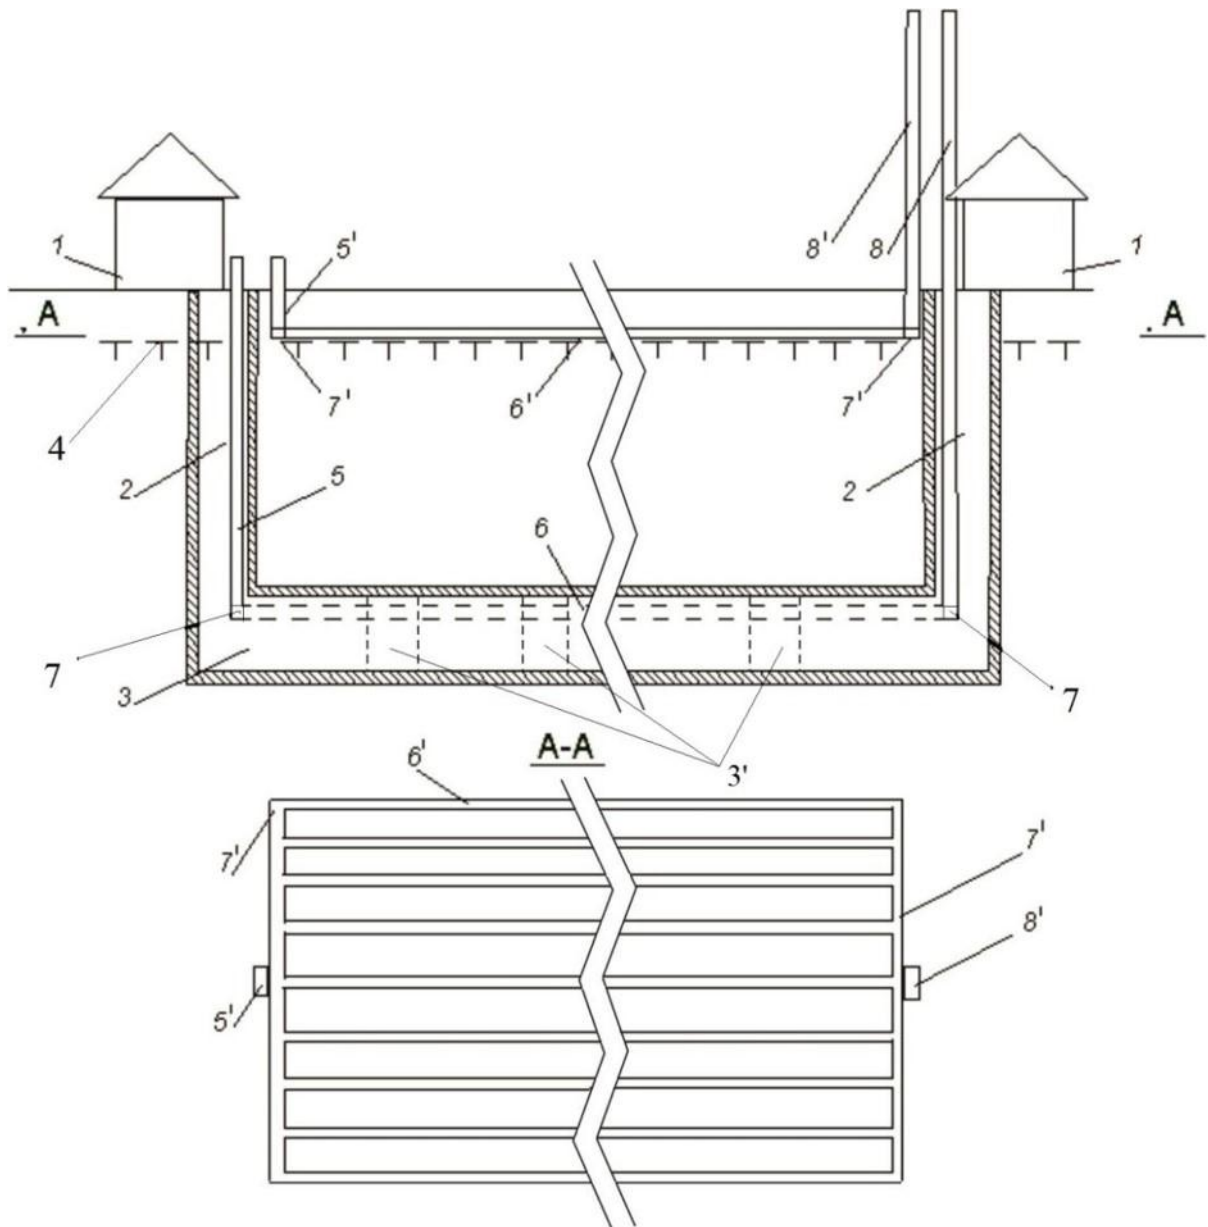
Схема воздушных охлаждающих установок криохранилища:
